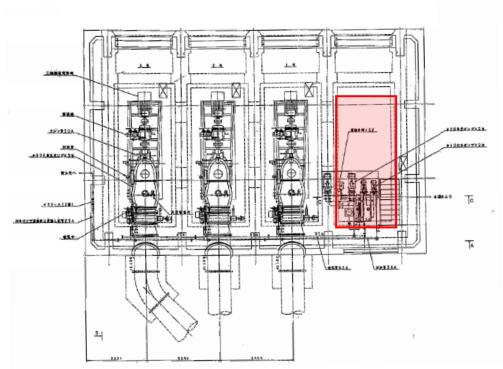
ポンプ室平面図 (赤枠内は増設可能スペース)
